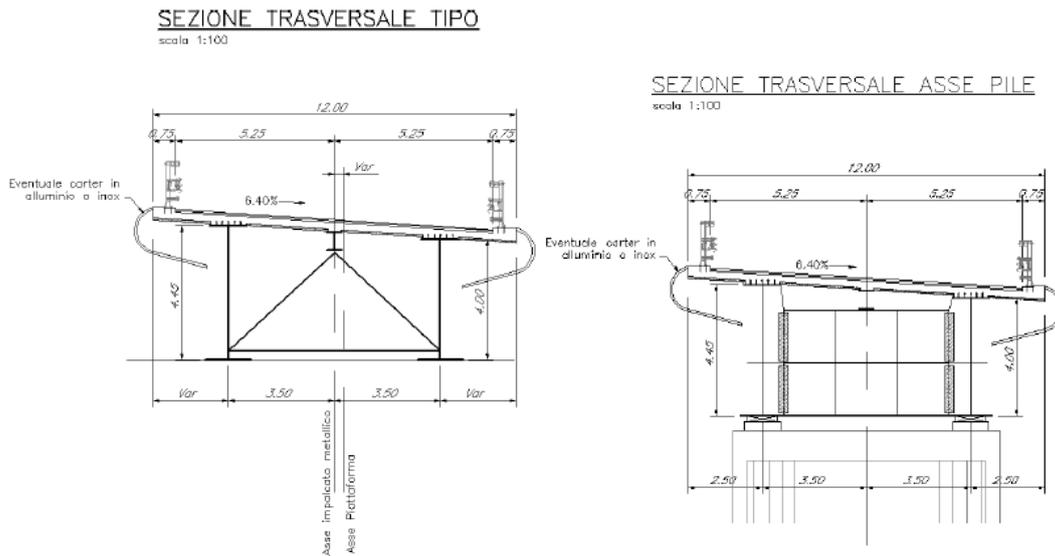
Sezioni trasversali tipo in asse alle pile e corrente
